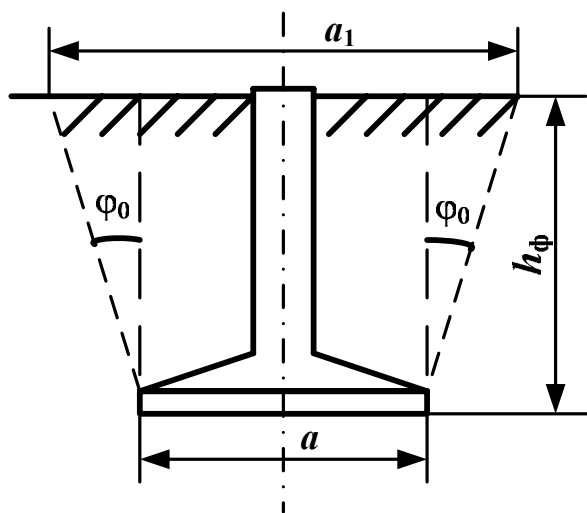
Расчетная схема при действии на грибовидный фундамент вырывающей нагрузки
